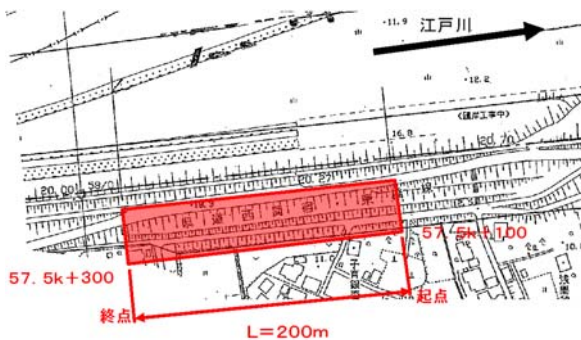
被災箇所周辺の平面図 (関東地方整備局提供)
